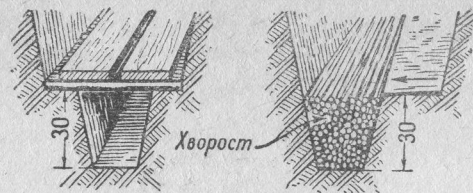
Устройство водоотводных канавок в плохо пропускающем воду грунте
